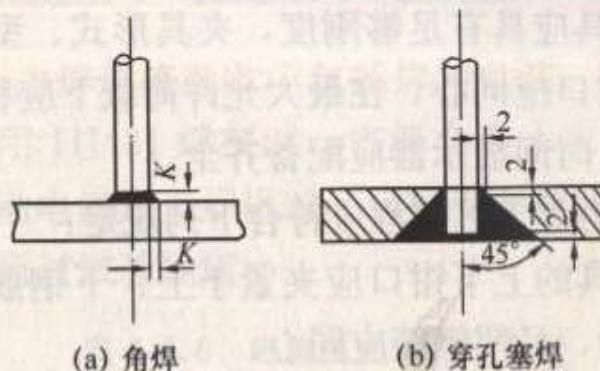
预埋件钢筋电弧焊 T 形接头
